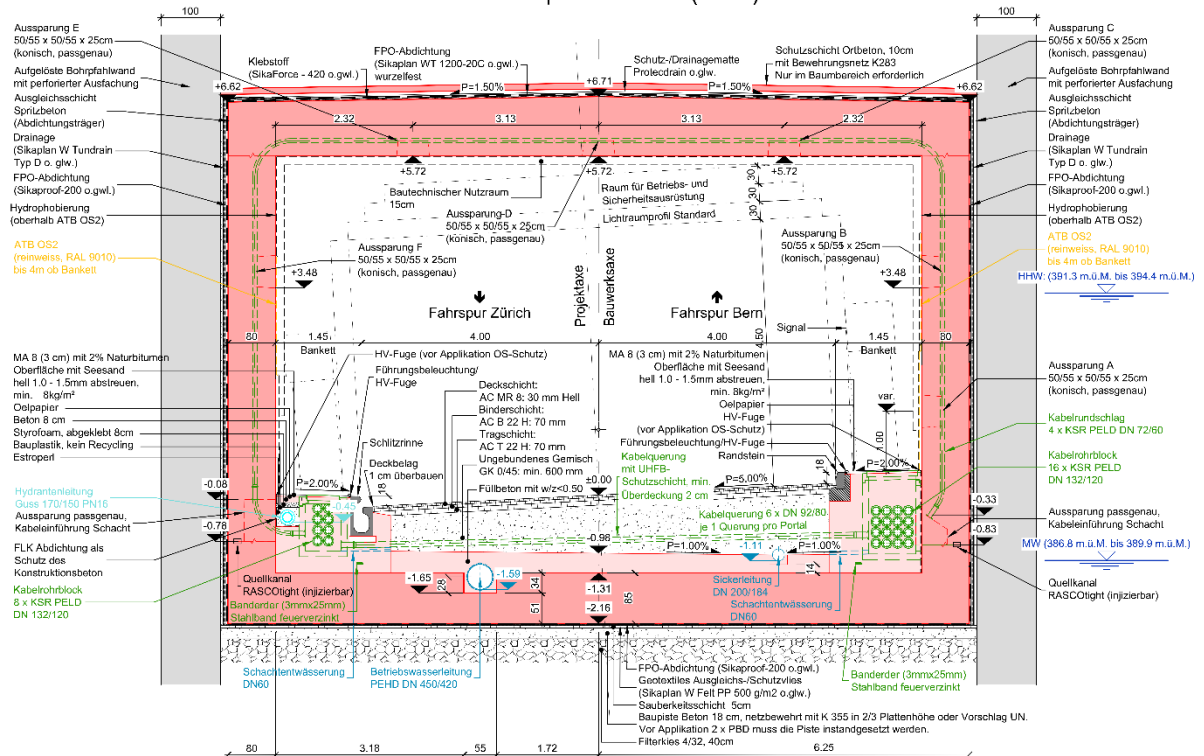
QP Rechteckprofil Tunnel Wynematte
